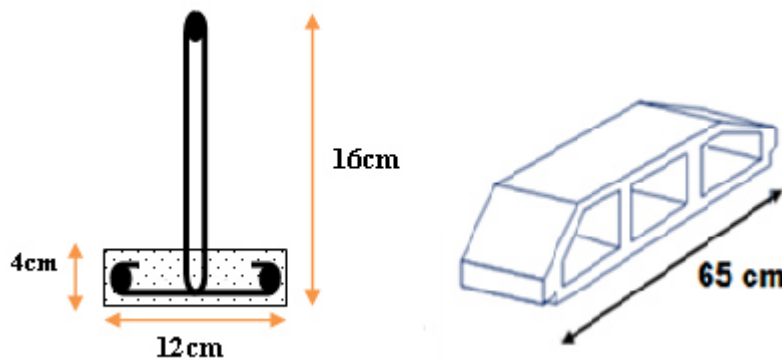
Poutrelle préfabriqué et corps creux.
